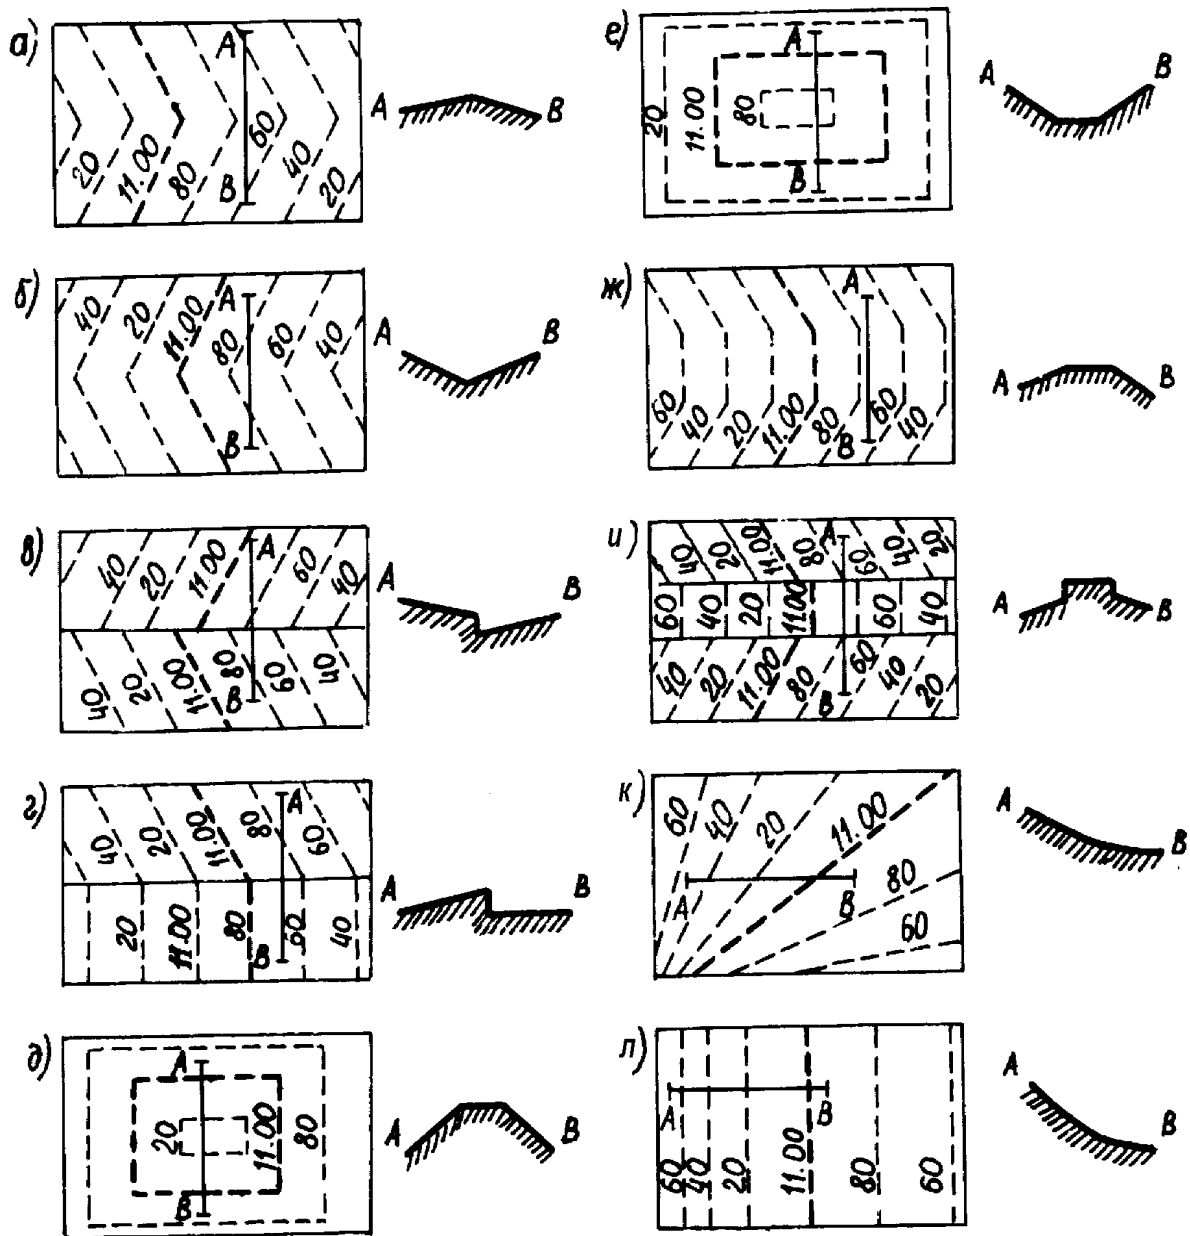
Зображення проектними горизонталями планованої поверхні: а – опукла з гребенем; б – увігнута з лотком; в, г – розділення поверхонь бортовим каменем (підпірною стінкою); д – пагорб; е – котловина; ж – сполучення трьох площин; и – розділова смуга на проїжджій частині; к – помірно нахилена; л – нахилена.
